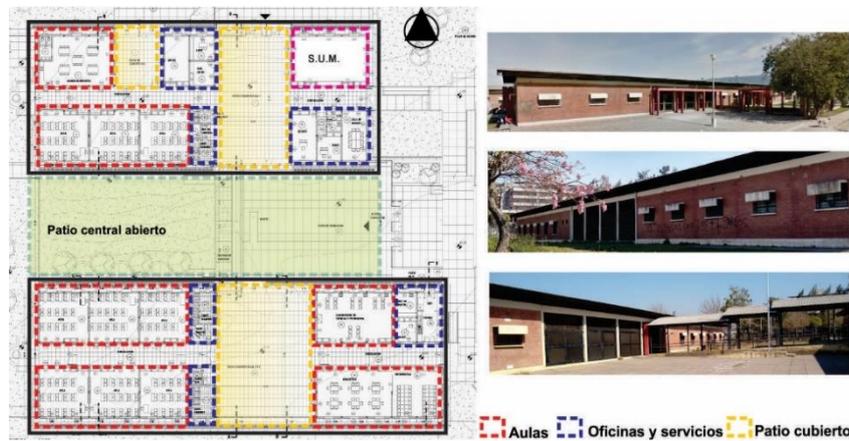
Planta tipo de análisis, con sectores y vistas generales Fuente: Elaboración propia
